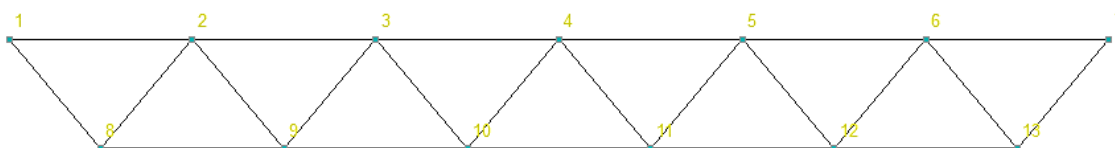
Расчетная схема балочной фермы в программе SCAD.
